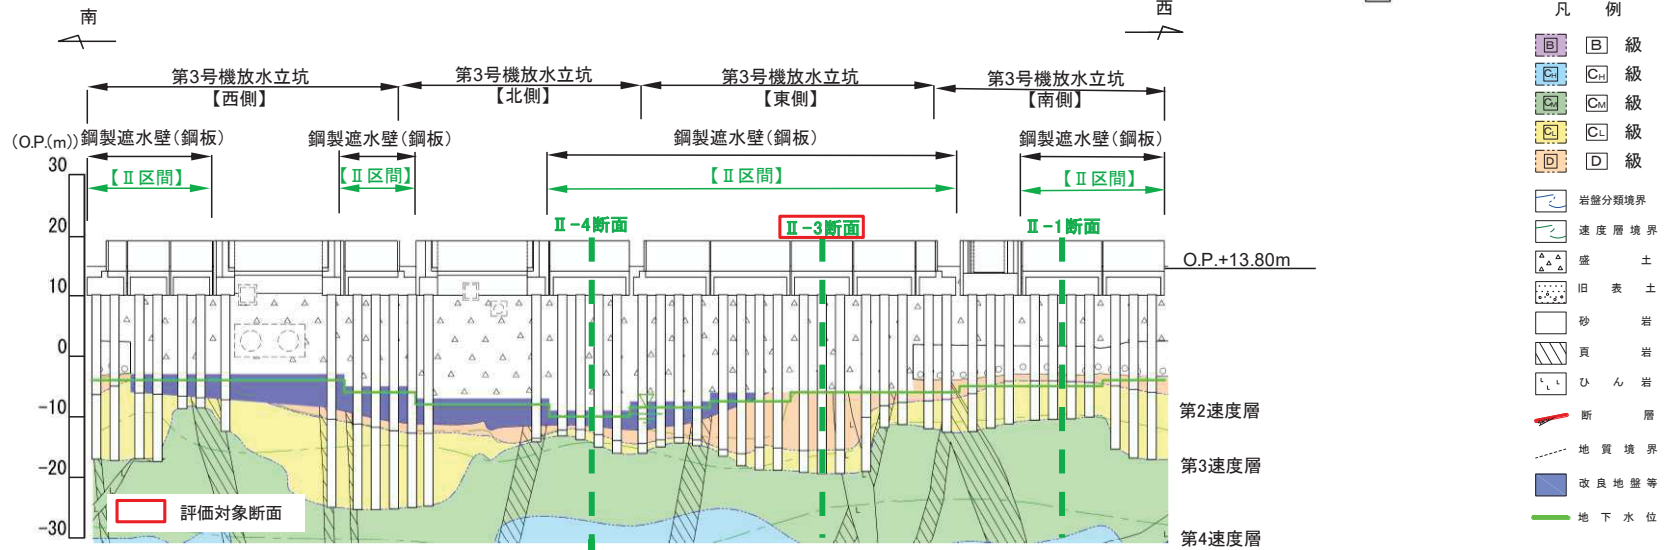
(4) 評価対象断面の地質縦断図 (第3号機放水立坑)
